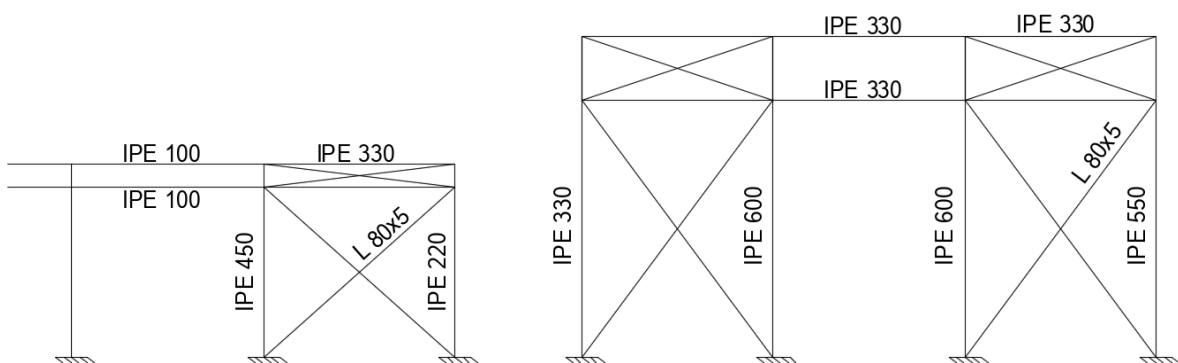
y 20: Sistema de contraviento en las fachadas laterales: Zona baja (izquierda) y zona alta (derecha)
